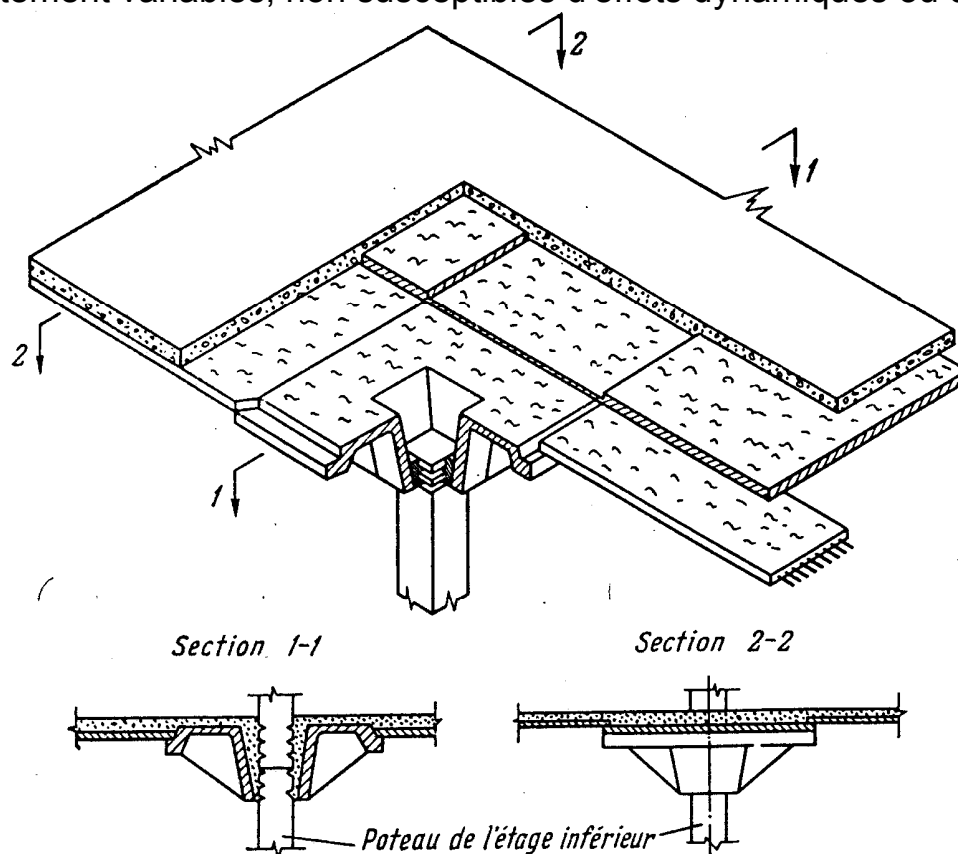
Exemple du plancher à pré-dalles préfabriquées
